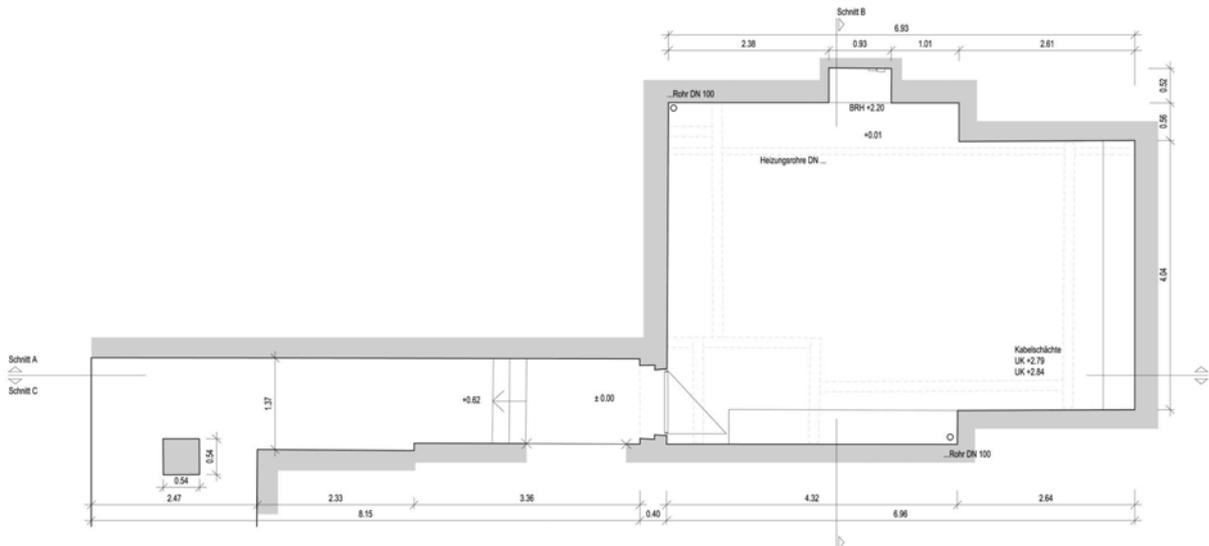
AutoCAD, Grundriss 1:50
